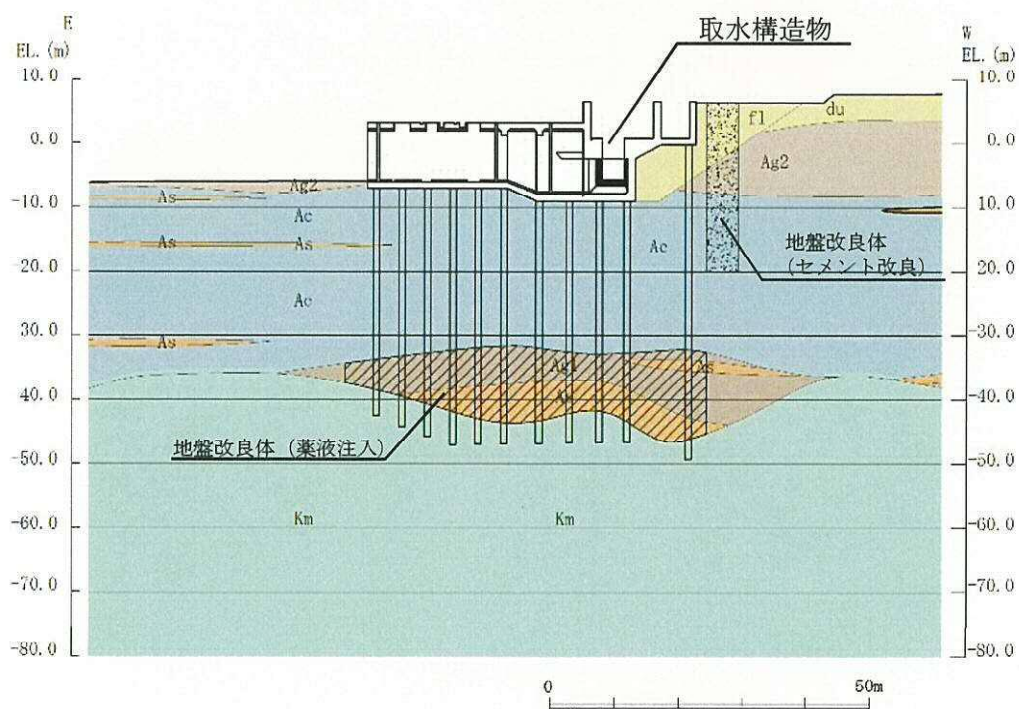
(3) 地質断面図 (⑥-⑥断面)
